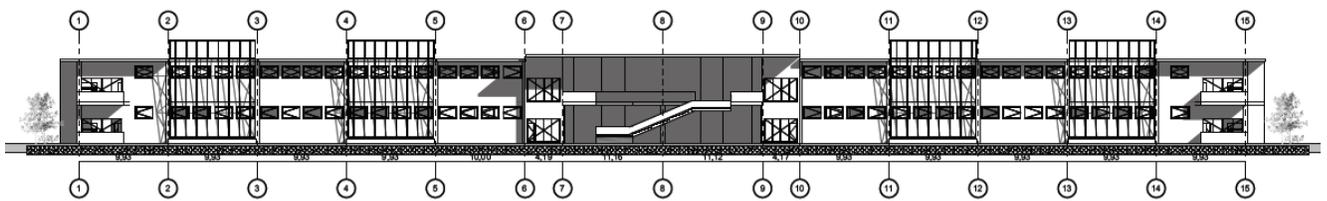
3D Fachada lateral derecha Apartamentos sub-oficiales casados
